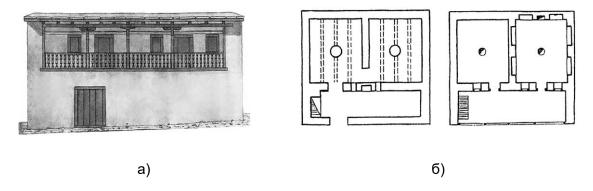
Длиннопланный дом в с. Куруш: а) фасад; б) план первого и второго этажа
